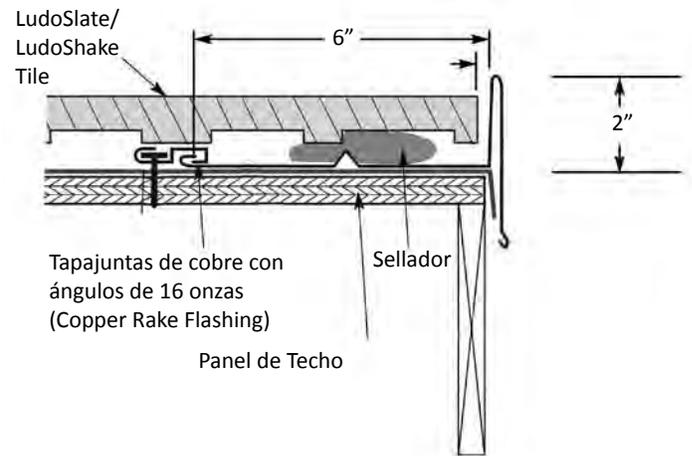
Detalle de tapajuntas de cobre con ángulos (Copper Rake Flashing)
